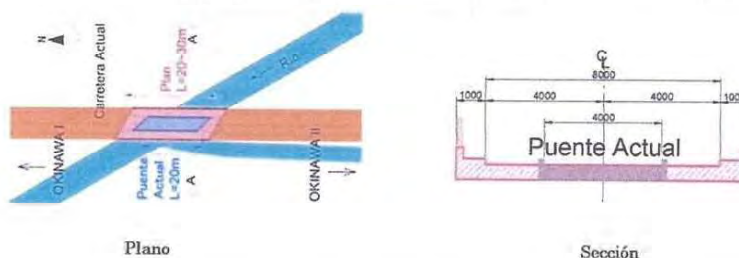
Plano de ubicación del puente a ser reconstruido
